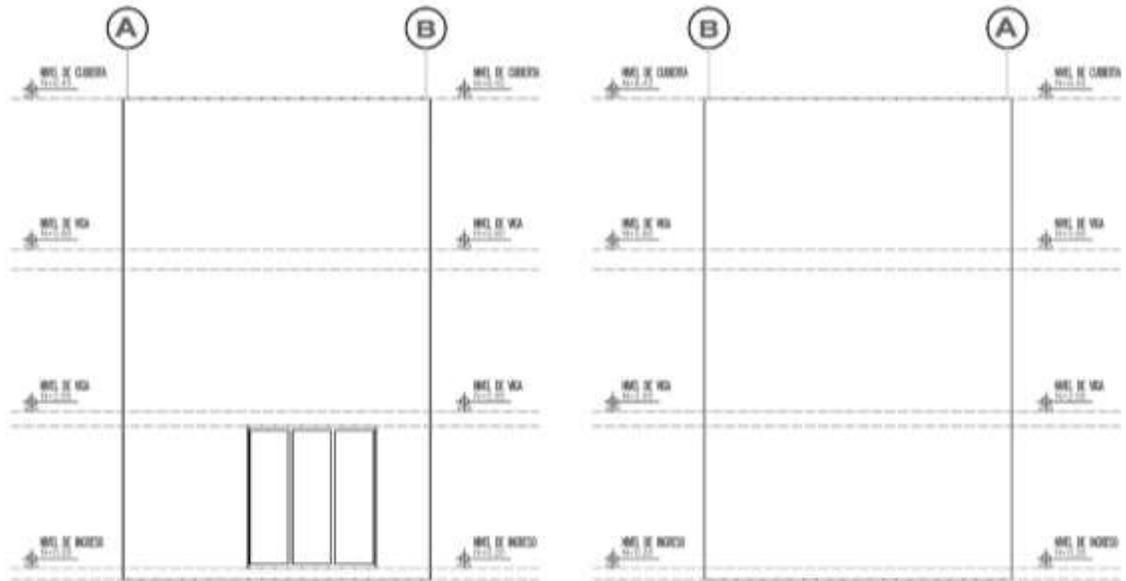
Fachada lateral izquierda / Fachada lateral derecha.
